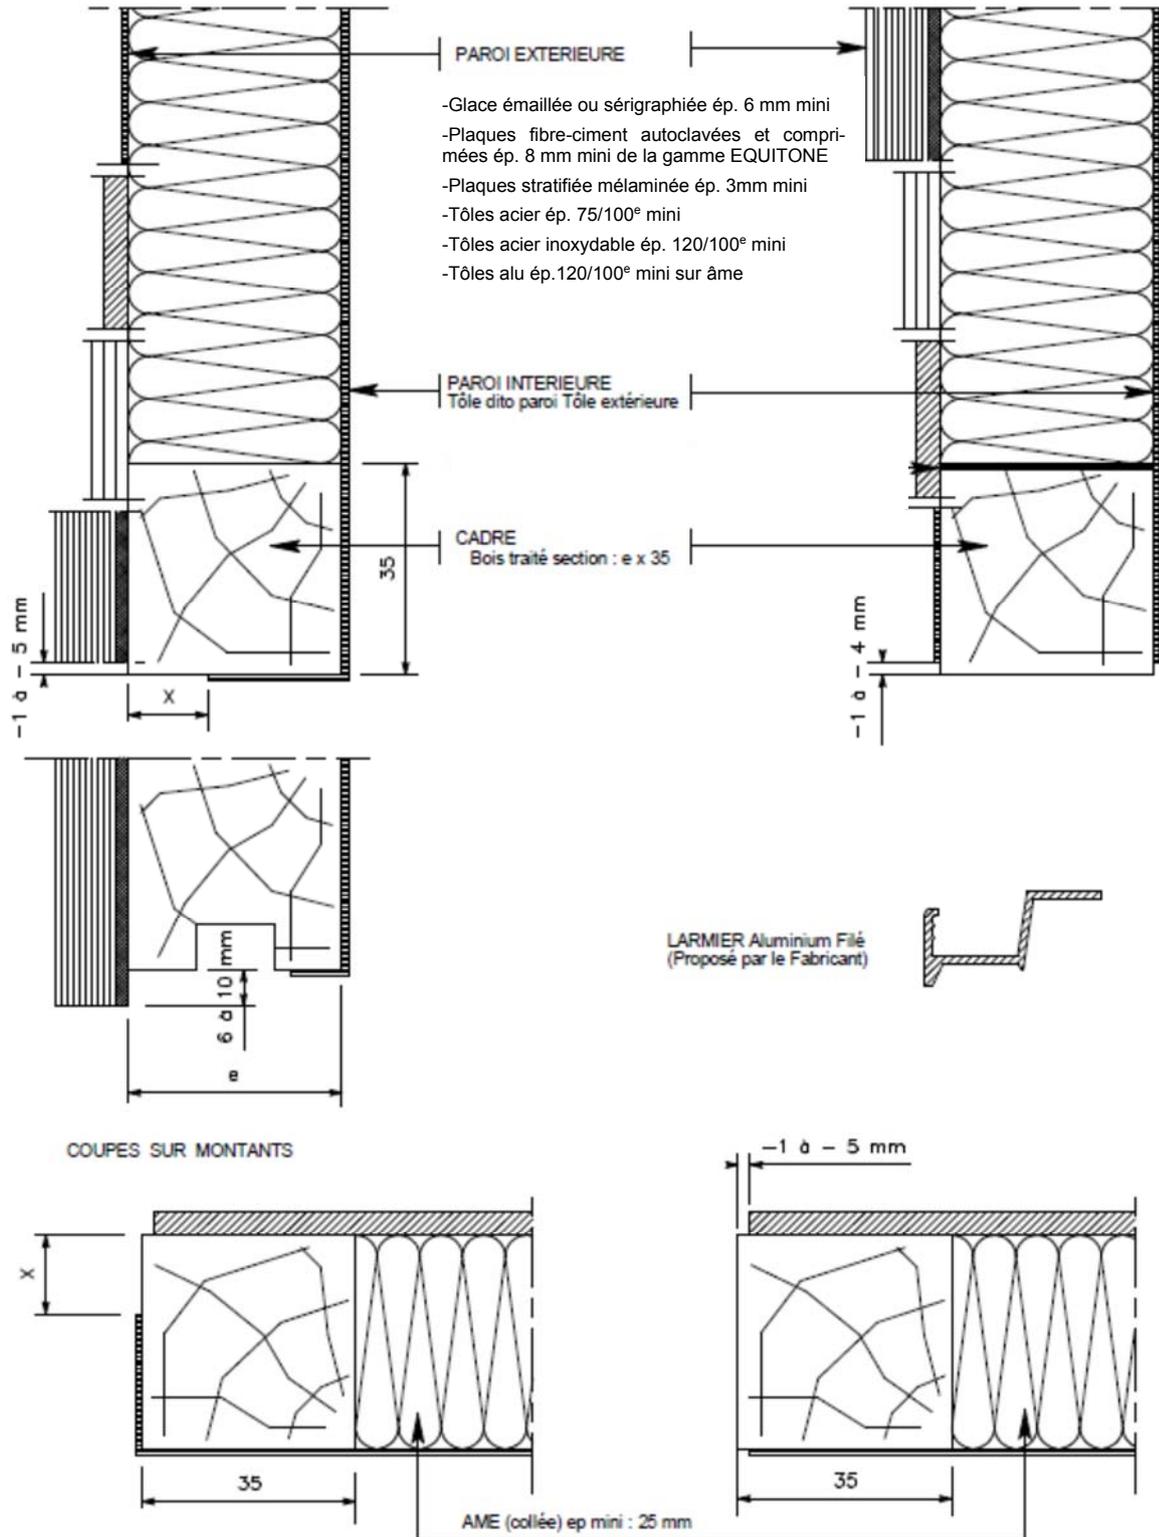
EdR PANNEAUX DE FACADE CB-P - Coupes verticales basses
